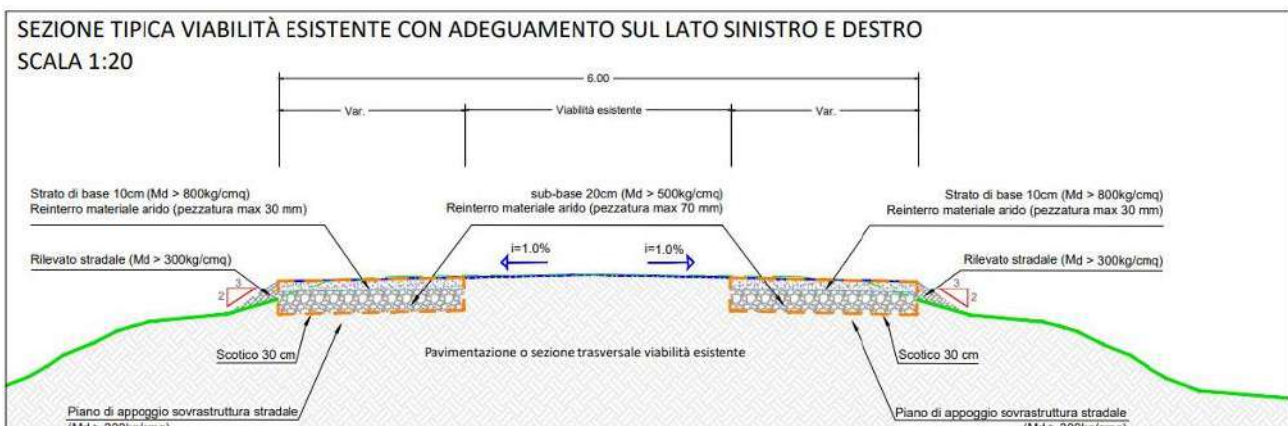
Sezione tipica viabilità esistente soggetta ad adeguamento.
